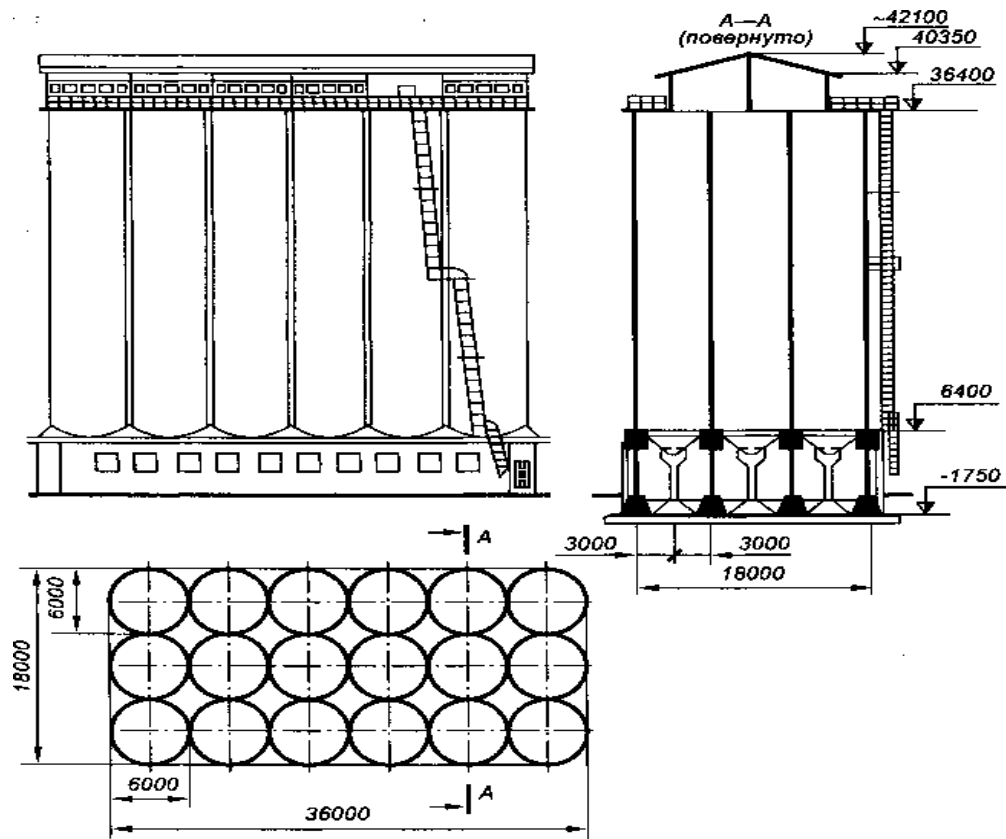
Приклад конструктивної схеми силосної споруди: а - фасад; б - план; в - поперечний розріз
